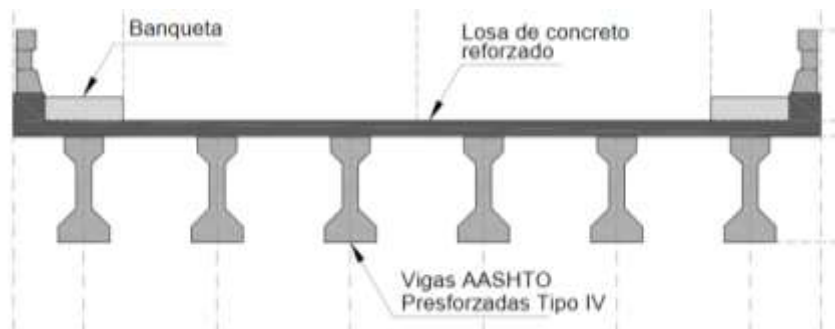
Vista transversal de la superestructura de un puente Viga-Losa.
